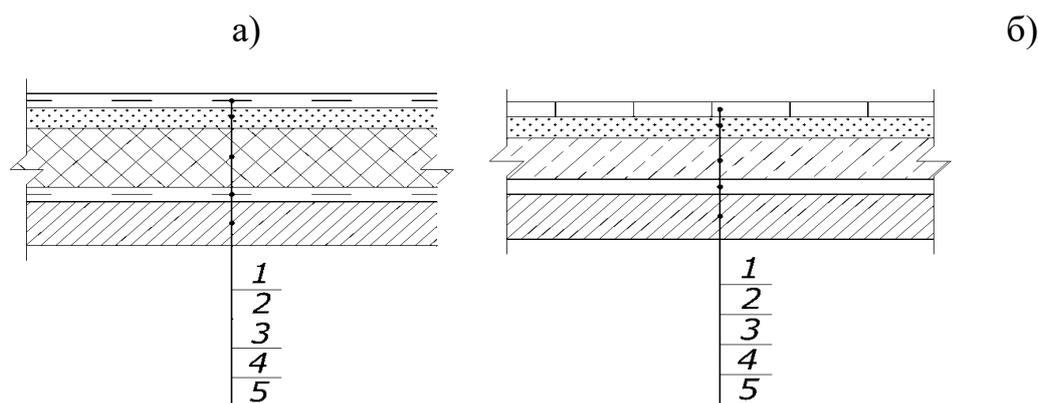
Состав: а) покрытия; б) перекрытия
